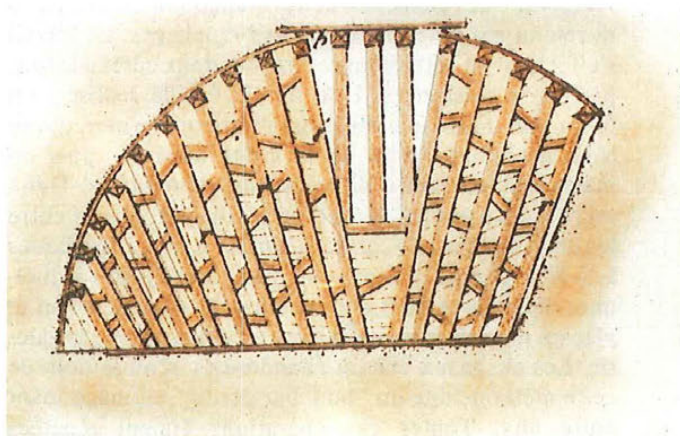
Construction de la voûte du tunnel de la Bête Refaite dont un profil en long est donné à la figure 36 (1828).
